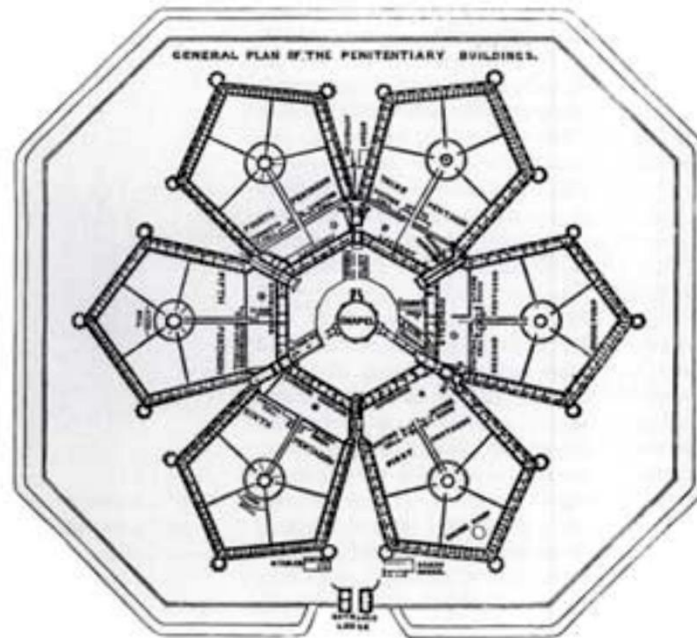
Prisão Millbank, Inglaterra (1821): Planta
